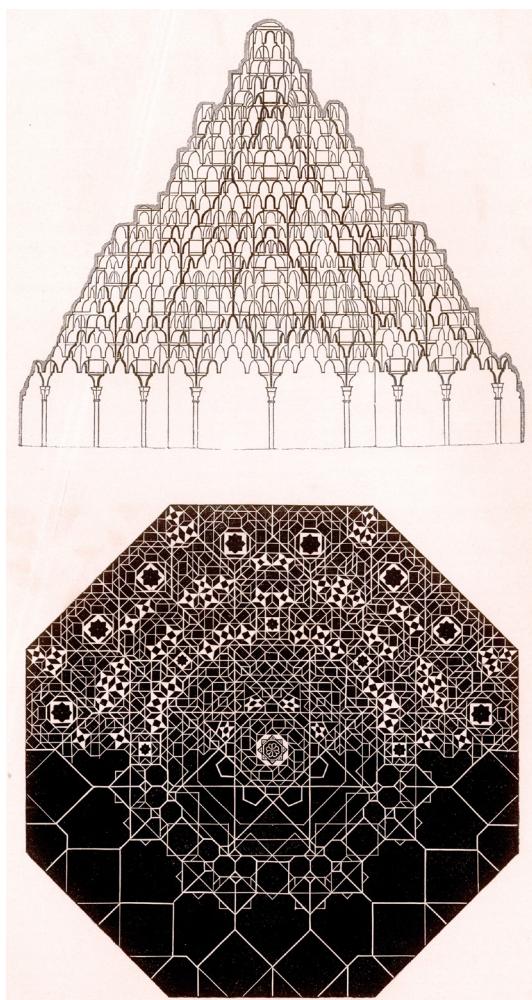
Jones y Goury. Detalle lámina X: Planta y sección de mocárabes en la sala de las Dos Hermanas.
